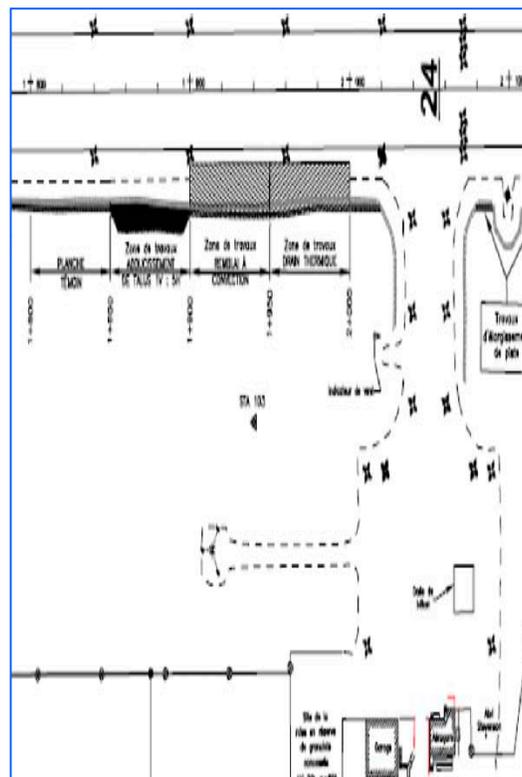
Construction de la section « pente adoucie » à Tasiujaq
